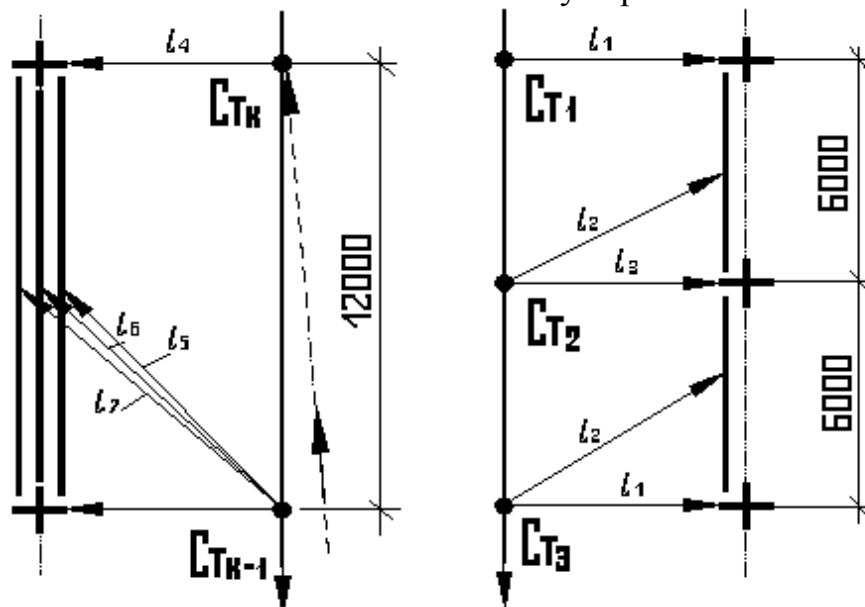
Визначення монтажного вильоту стріли крана під час здійснення монтажу конструкцій першим краном
